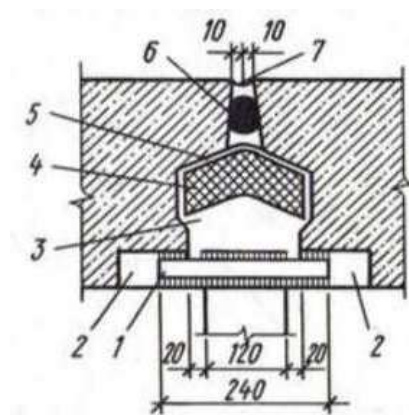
Конструкція вертикального пружноподатливого стику панелей: 1 – сталеві накладки; 2 – закладні деталі; 3 – важкий бетон; 4 – термовкладки; 5 – смуга гідроізолу; 6 – герніт або пороізол; 7 – герметик
